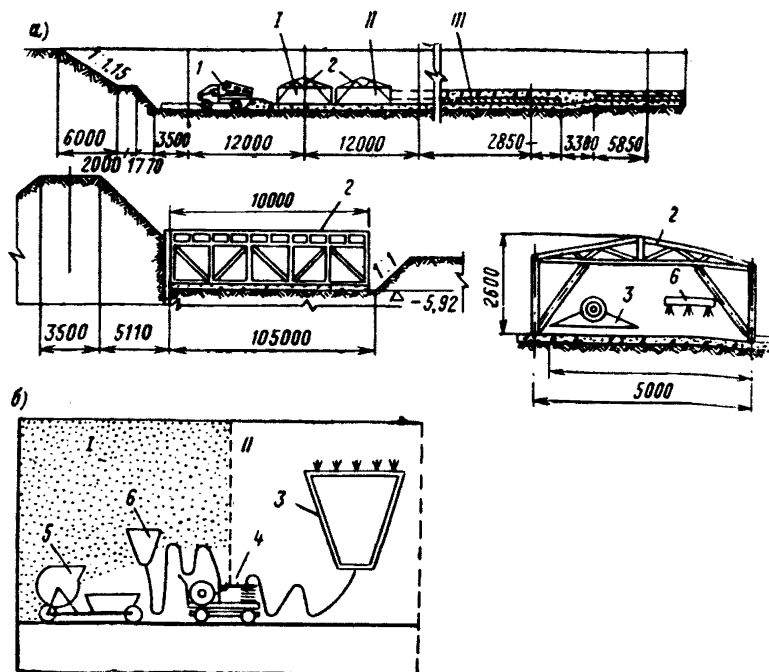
Схема организации гидроизоляционных работ в тепляках (а) и в закрытом помещении (б)
